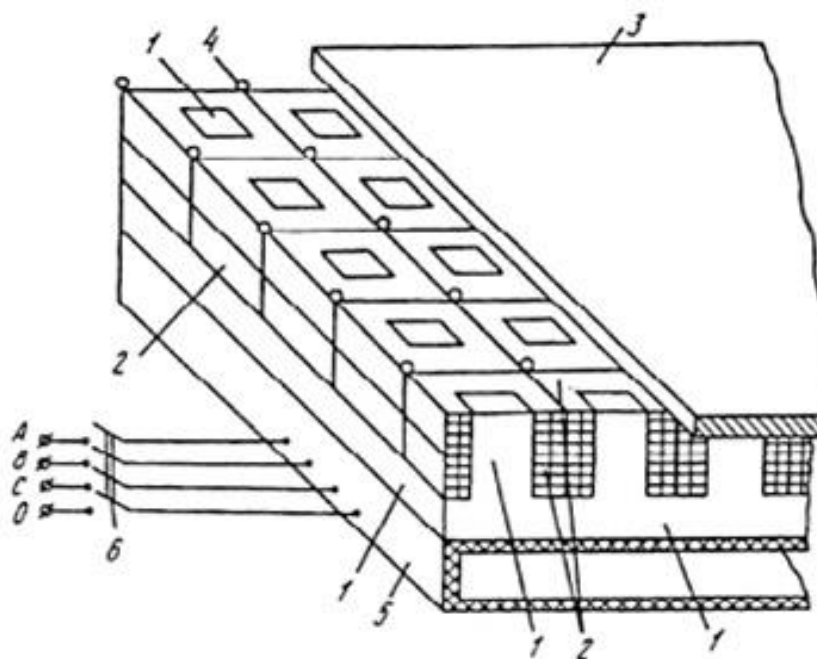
Двухкоординатный линейный шаговый асинхронный двигатель:
